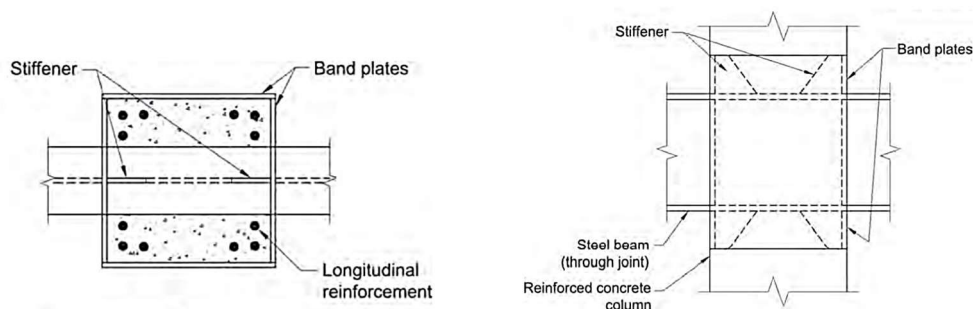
鋼筋混凝土柱與鋼梁接合 (AISC 341-16, 2016)
